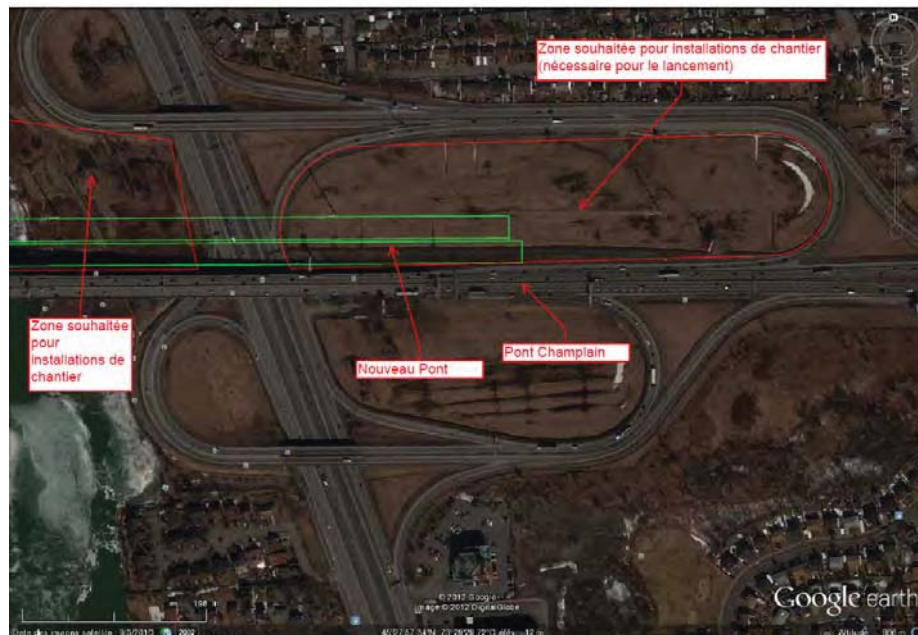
Installation de chantier – Montréal et Île-des-Sœurs
